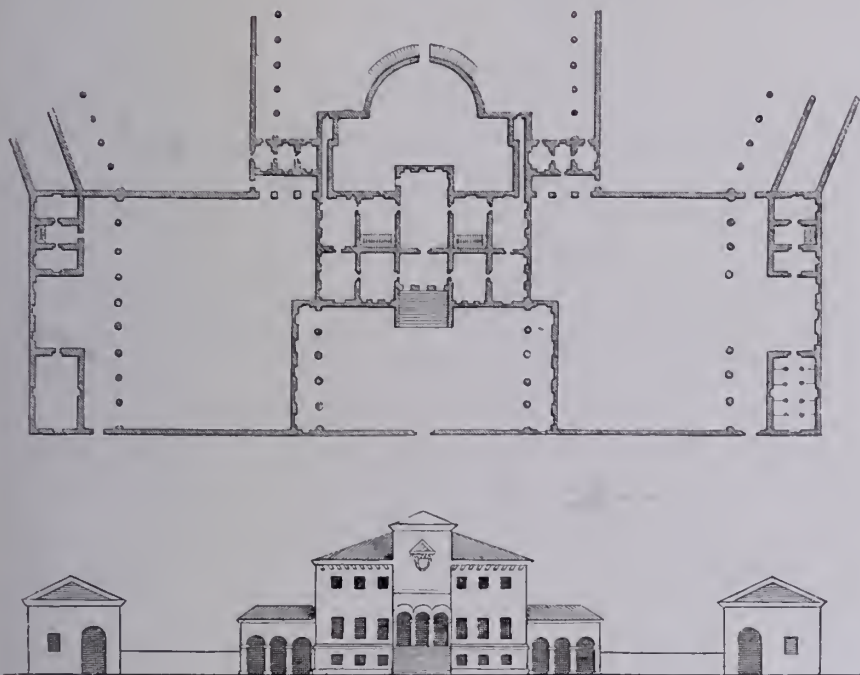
Lonigo nel Vicentino, Villa Godi. Palladio: Pianta e prospetto.
